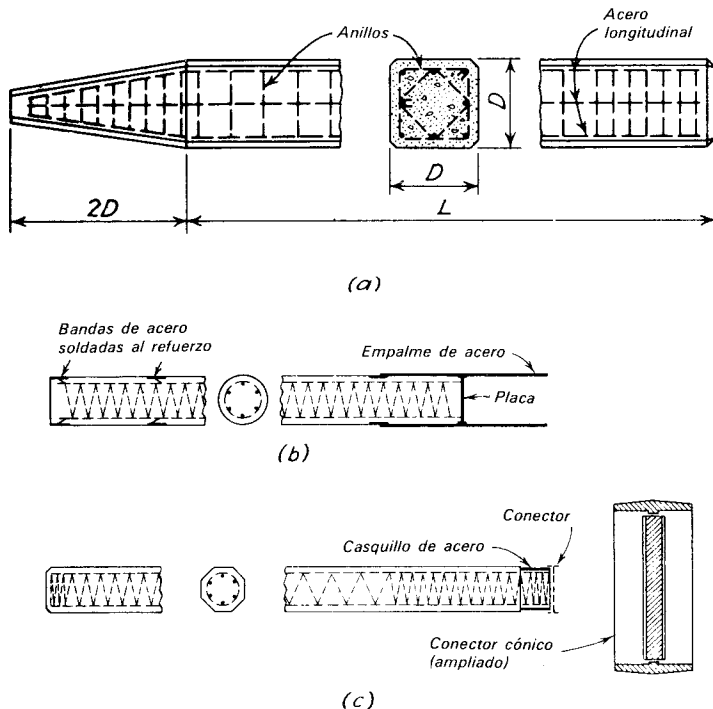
Ejemplos de pilotes precolados. *a*) Tipo comúnmente usado para caballetes de puente. *b*) Seccional (Fuentes) con conexiones hechas soldando el mango a la tira de acero después de insertar la siguiente sección. *c*) Pilote seccional preesforzado (Brunspile) con conexiones hechas introduciendo un casquillo apretado de acero en un conector ligeramente cónico.
